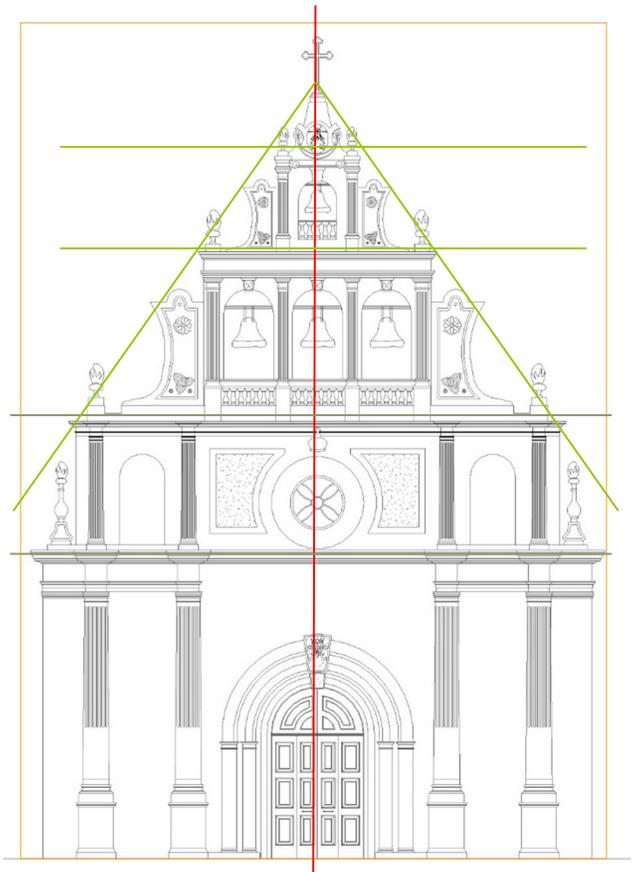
Fachada Beatas de Belén. Sin escala. Elaboración propia.
